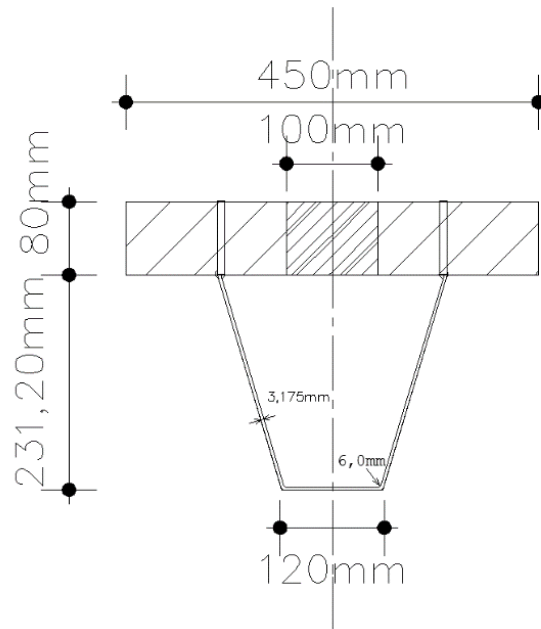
Sección transversal, ancho efectivo de la viga, $b_e = 450\text{mm}$
